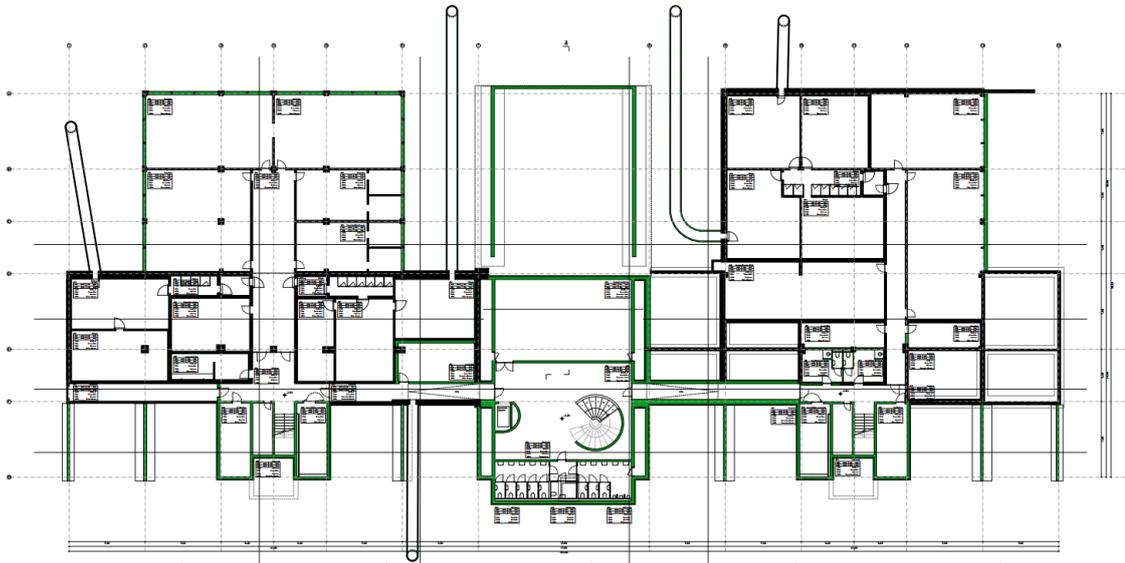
Pianta piano cantina– Durisch + Noll Architetti sagl
